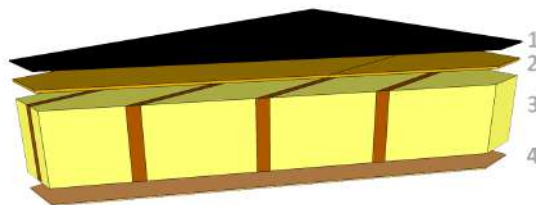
Composition de la toiture de la construction PailleTech (Delvenne, F. 2016)
